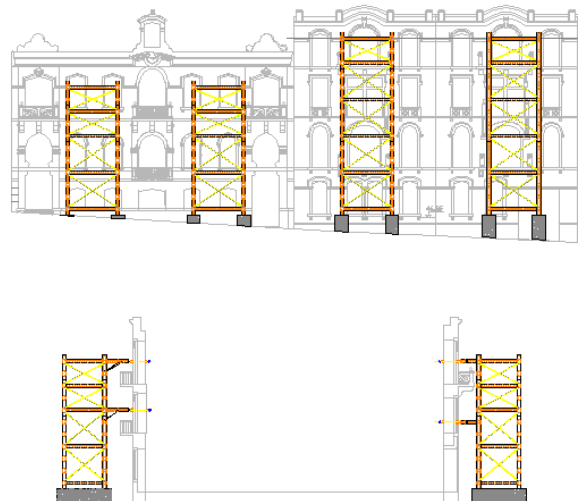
ESTRUTURAS DE CONTENÇÃO DE FACHADA, ALÇADO PRINCIPAL E CORTE TIPO, ADAPTADO DE [44]
